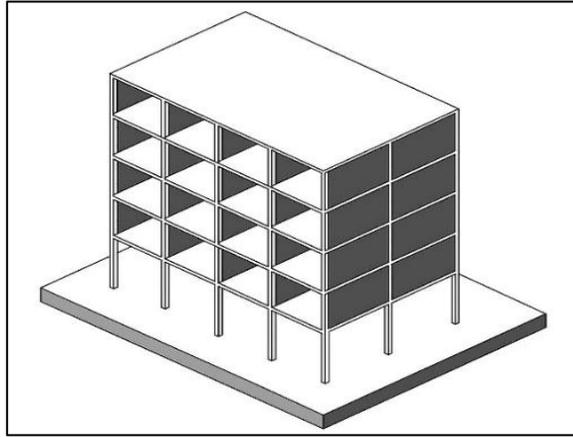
Entrepiso Blando por Ausencia de Paredes Rígidas en Planta Baja.
